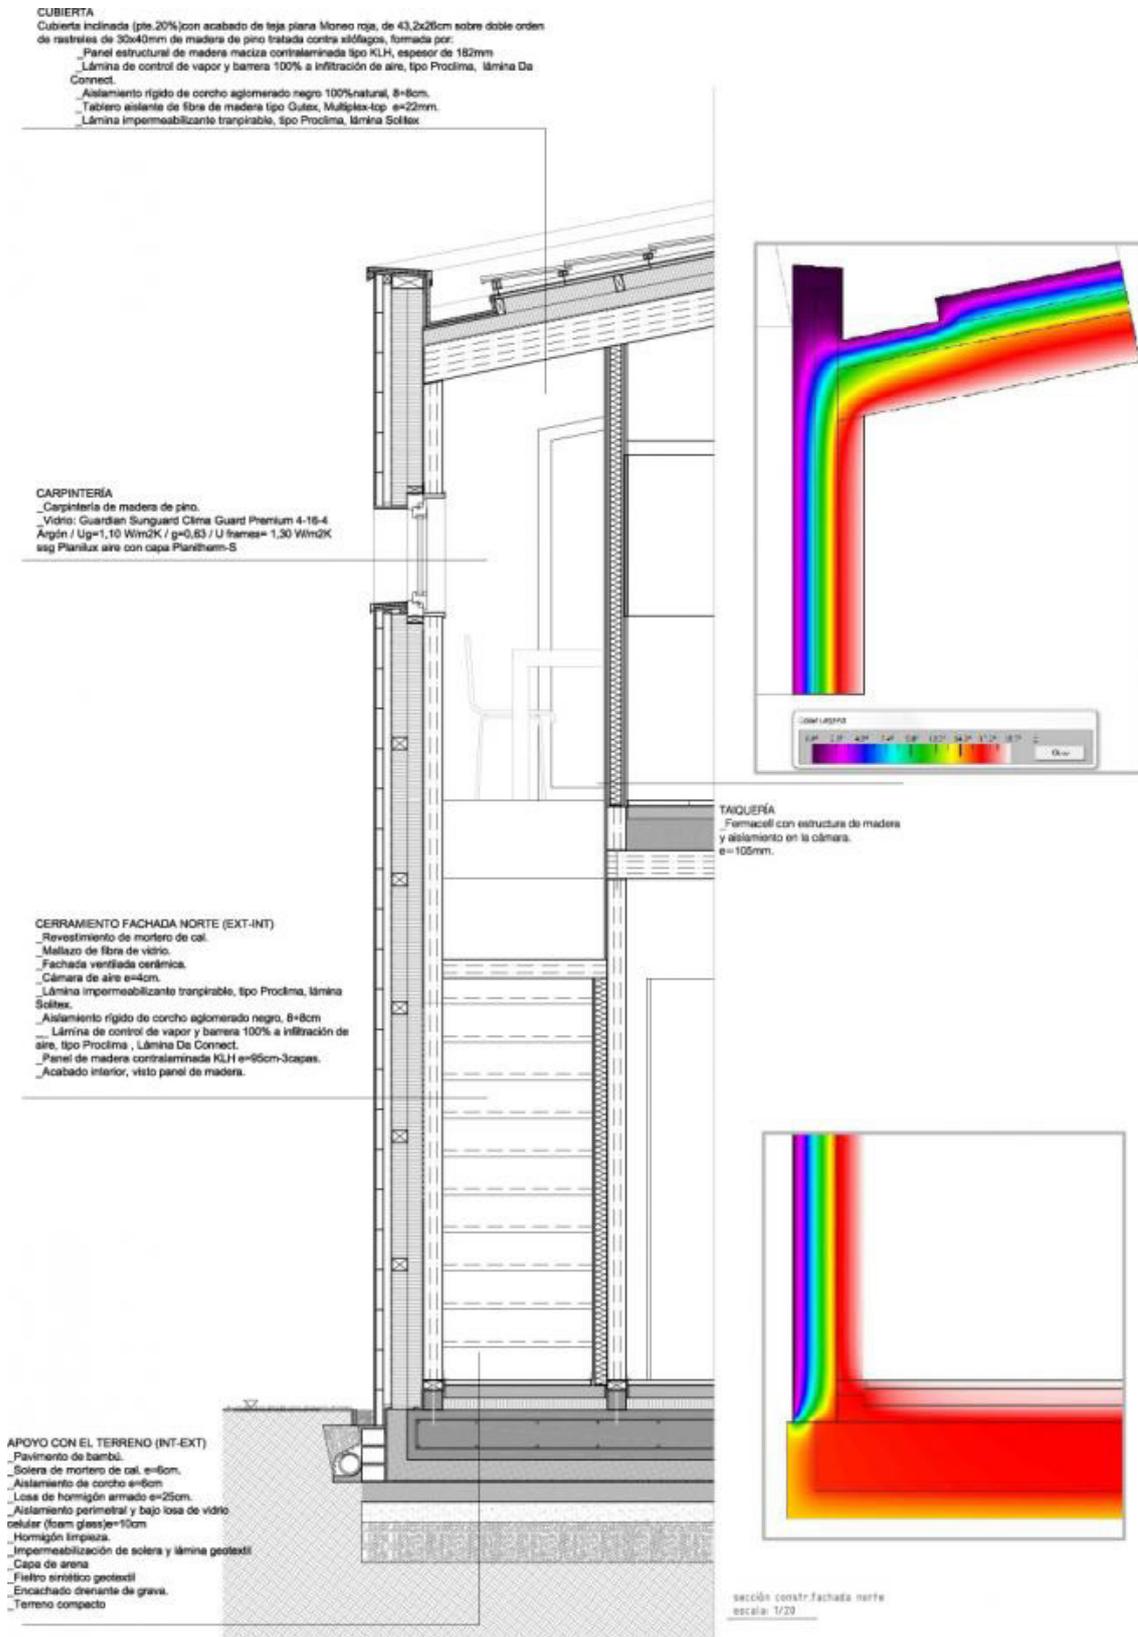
Sección constructiva y termograma de la misma. Fuente: Estudio Duque y Zamora Arquitectos
